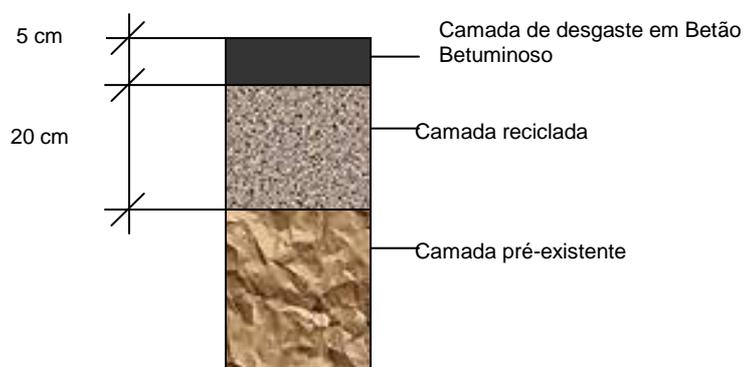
Estrutura final do pavimento reabilitado (EN12 – Estrada de Circunvalação do Porto)
